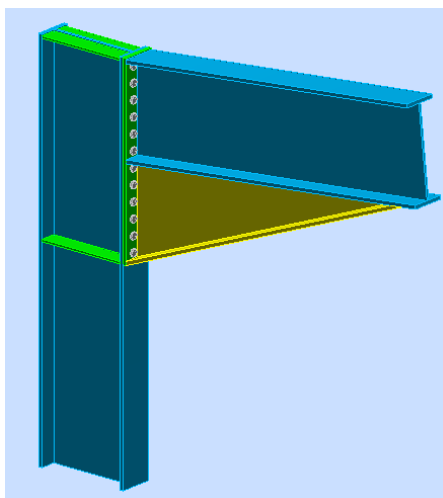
Pormenor 3D da ligação Pilar-Travessa com esquadro rigidificador
